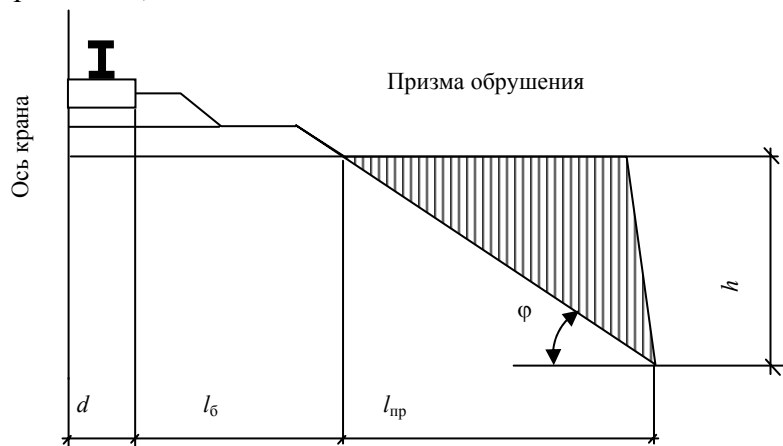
Расчетная схема расположения подкранового пути при открытом котловане
